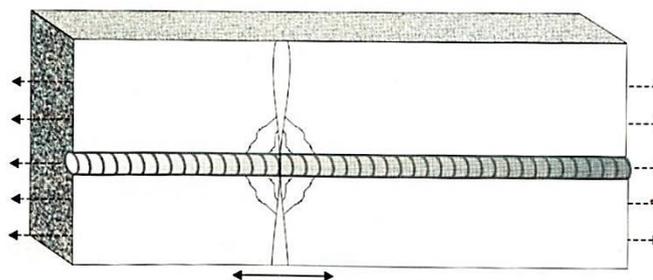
25 GRIETAS DE TRACCIÓN PURA, CON INTERRUPCIÓN DE LA ADHERENCIA MECANICA ENTRE EL ACERO Y EL CONCRETO
